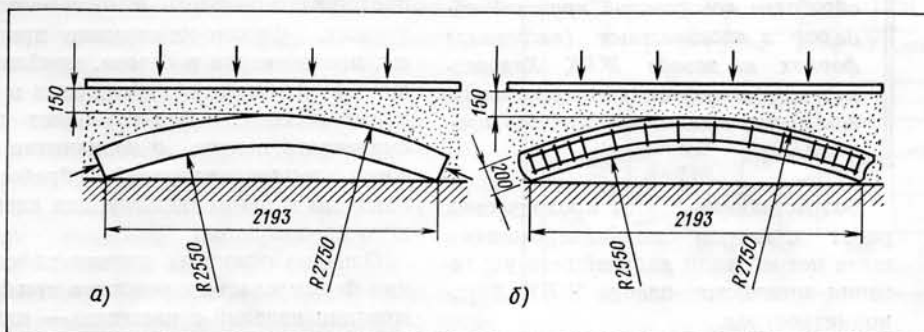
Схемы испытаний отдельных блоков: а — схема 1; б — схема 2.
